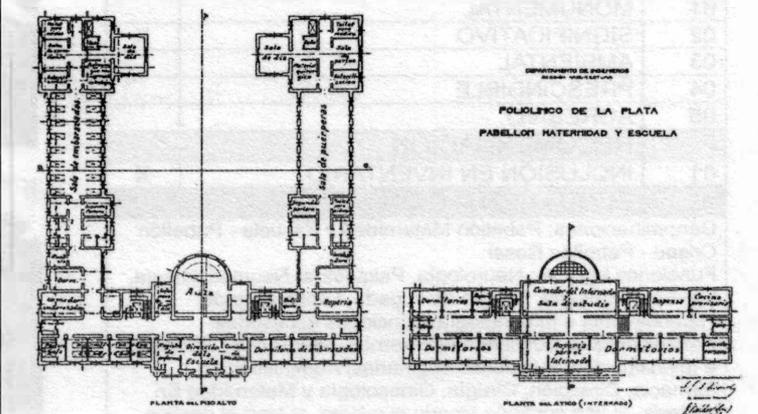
PLANTA PRIMER Y SEGUNDO PISO. 1918
